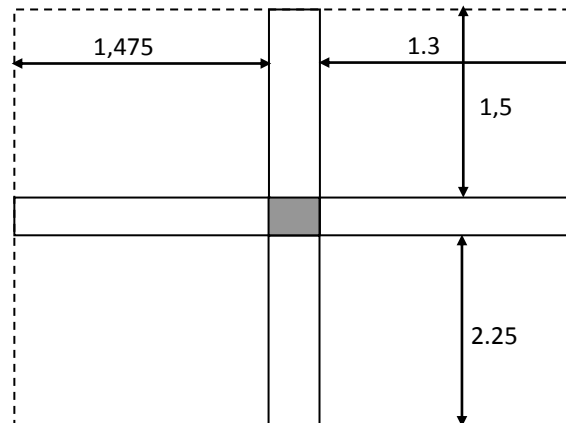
Surface afférente -Poteau 1(axe 4- B)
